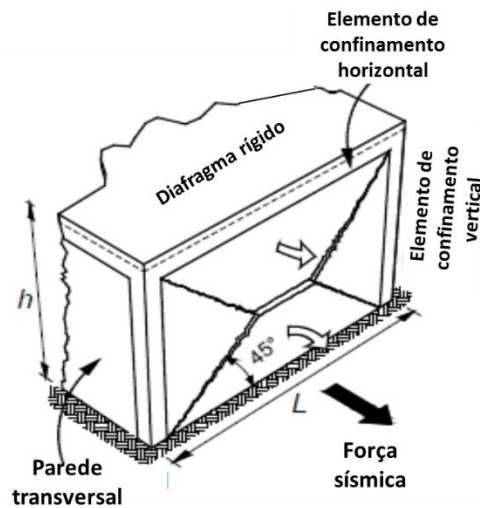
Comportamento de laje armada em duas direções (Meli e Brzev (2011)).
